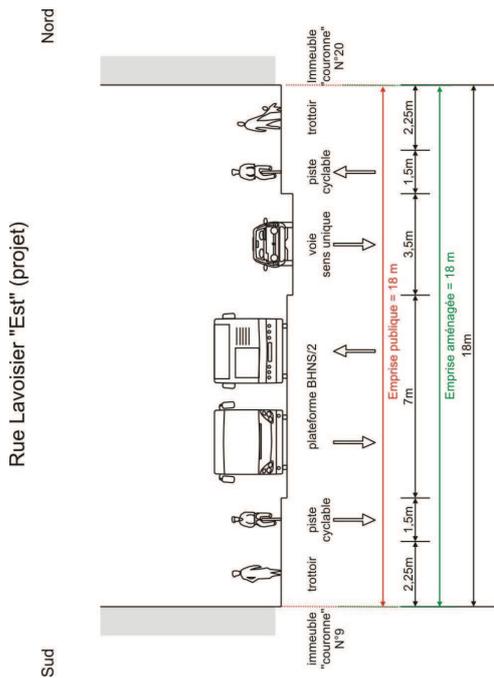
Situation projetée (coupe 35) rue Lavoisier « Est »
